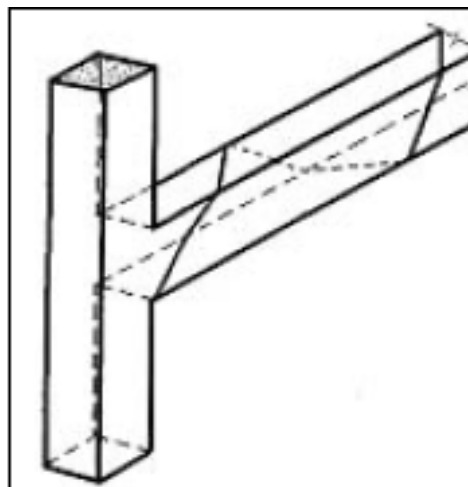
Fractura por cortante en la Pila. Puente U Shi. Taiwan
